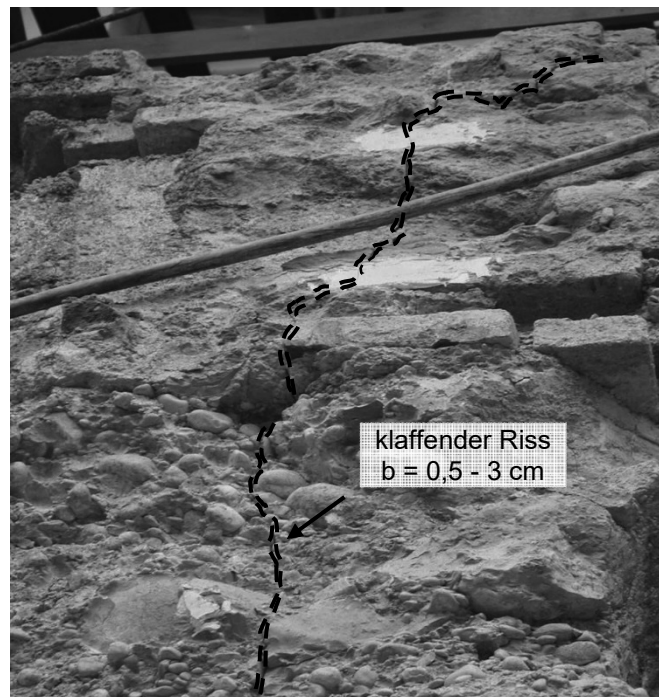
Klaffender Riss im Unterfangungskörper unter dem Stützgerüst der südlichen Fassade
